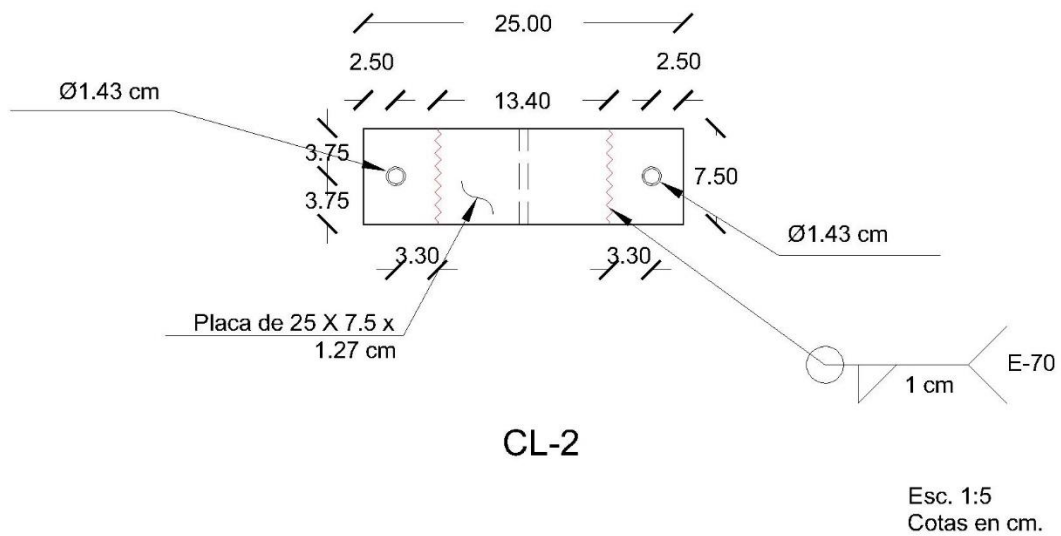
Detalle de viga de carga lateral (placas de anclaje y de conexión)
